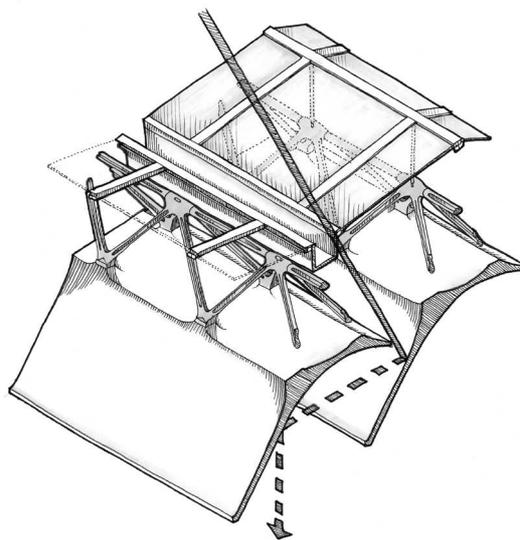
Menil Collection. Dettaglio del lucernario.
